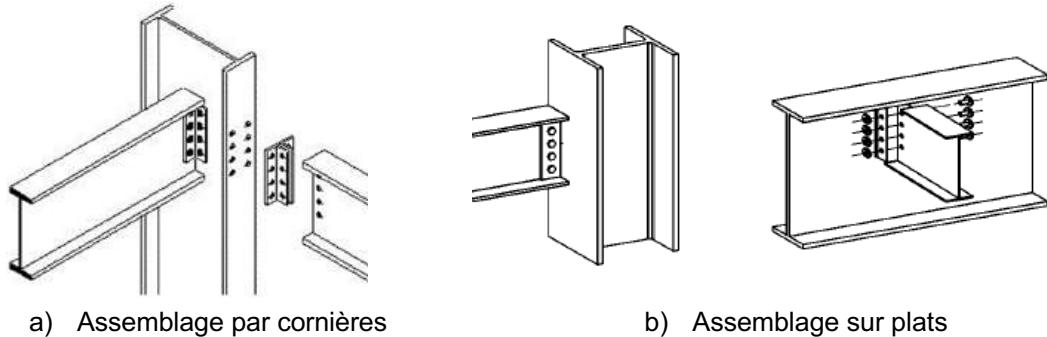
Assemblages recommandés pour les poutres du plancher de la mezzanine
